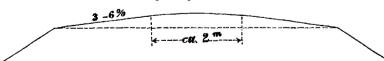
Dachförmiger Querschnitt mit Abrundung.
